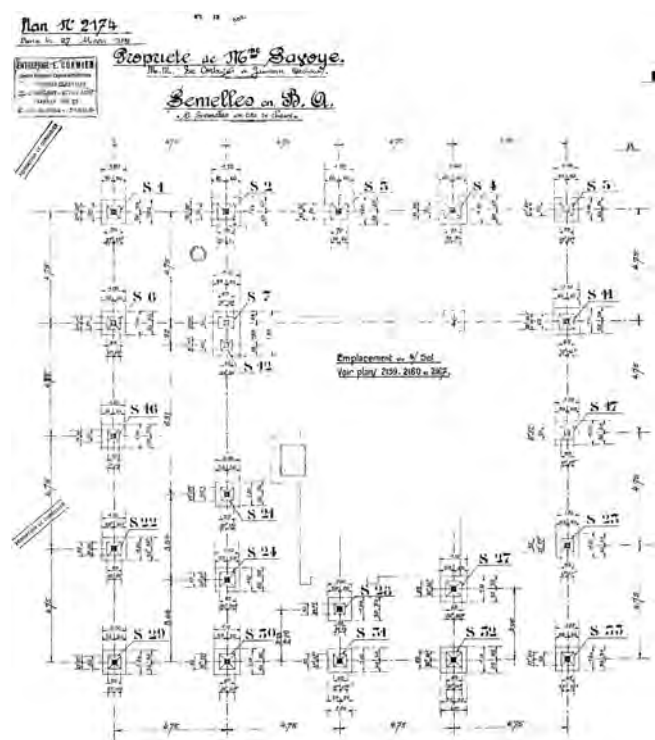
Detalle del plano de zapatas de la *Villa Savoye* (FLC-H1-13-302). Fuente: Fondation Le Corbusier.
